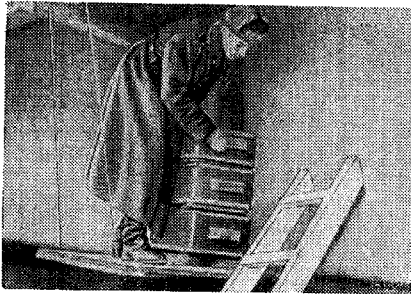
Крепление зарядов ВВ к главным балкам железобетонного моста при помощи комплекта.
